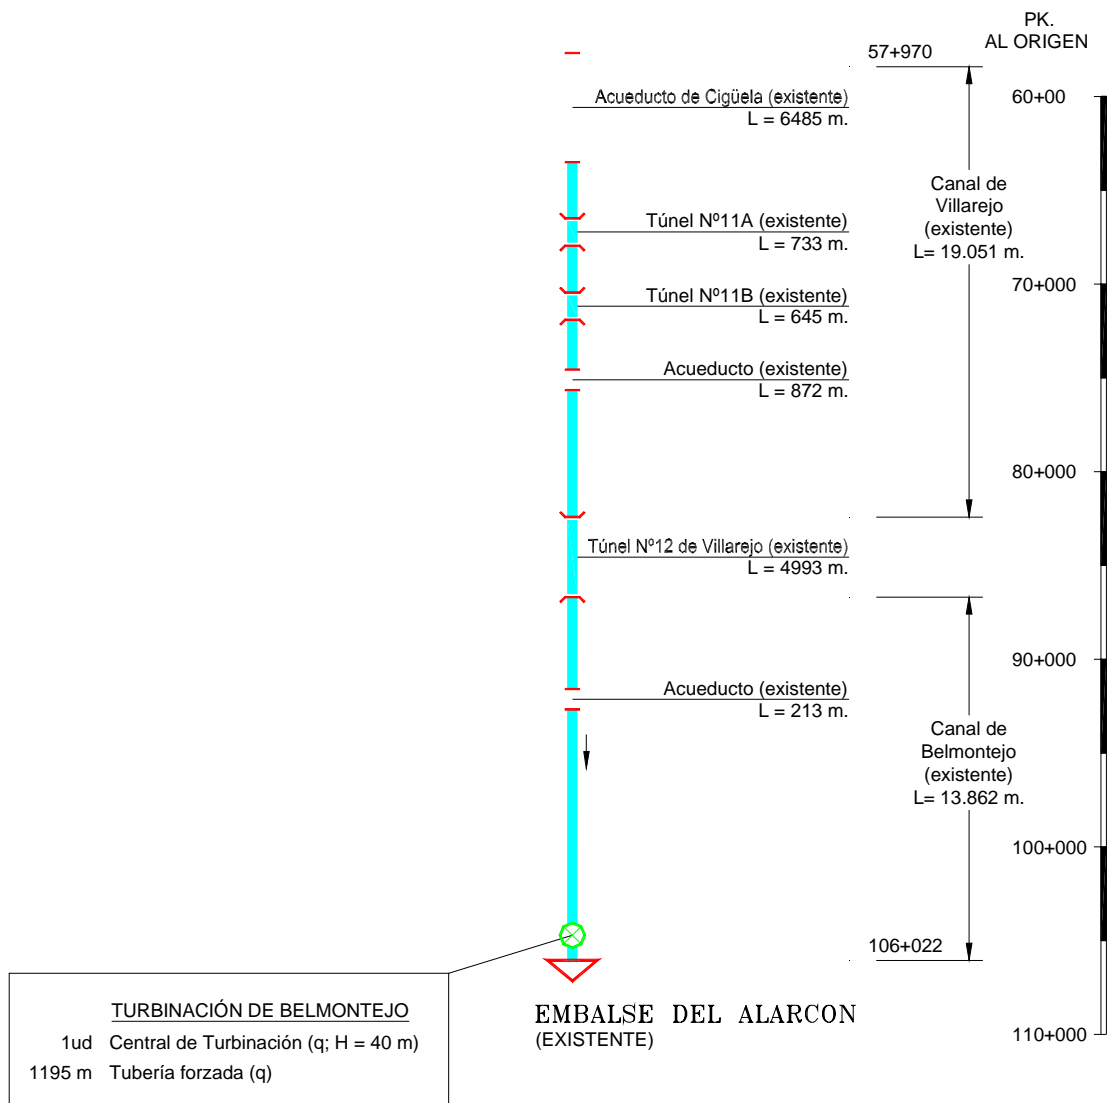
Conducción Cigüela - Alarcón. Esquema en planta
